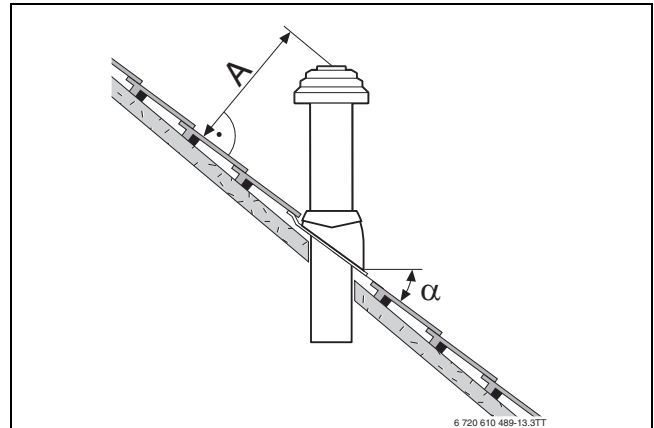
Abstandsmaße und Dachneigungen bei Schrägdach
